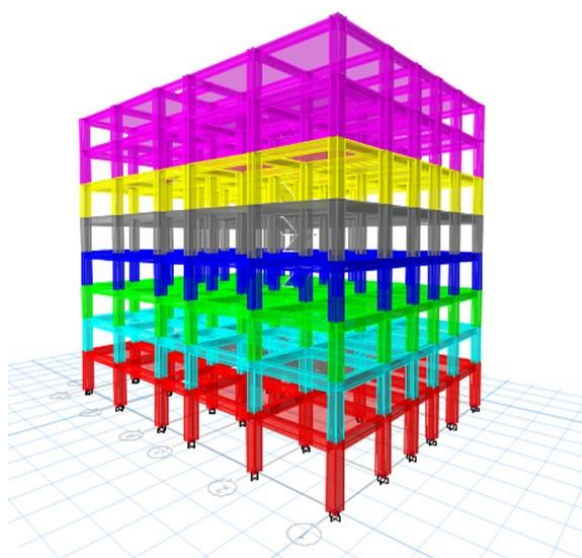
Vista del modelo de elementos finitos de la edificación de sistema estructural PRM convencional.
